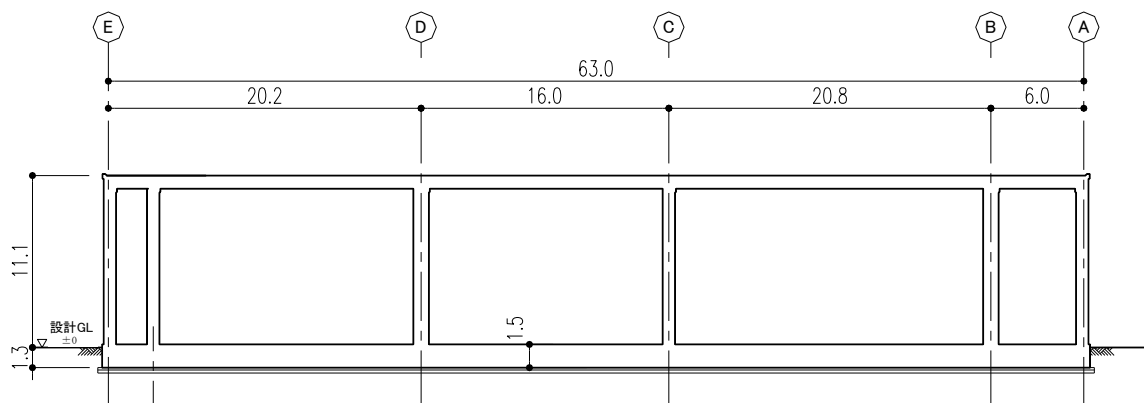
スラッジ棟 B-B断面図 (EW 方向) (単位 : m)
